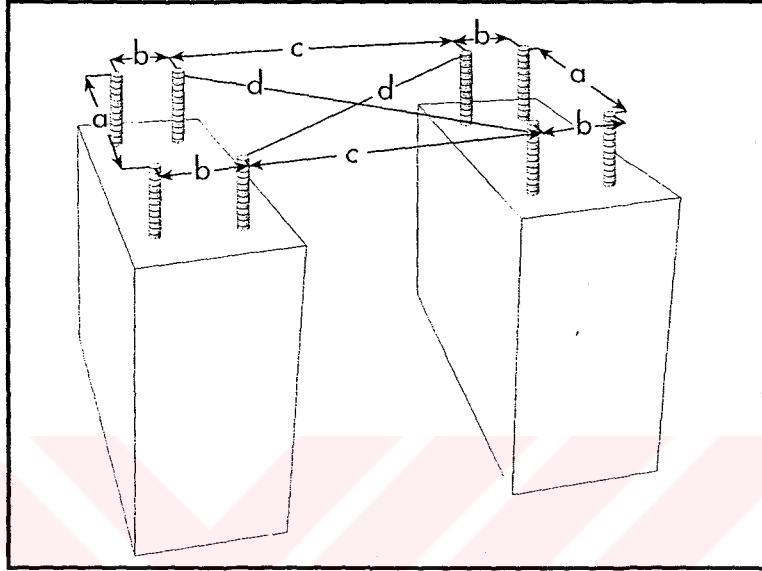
Tank havuzu ve beton ayak detayı (35-180m³) (Aygaz, 1999)Çizelge 6.4 Tank havuzu ve beton ayak ölçüleri (35-180m³)
